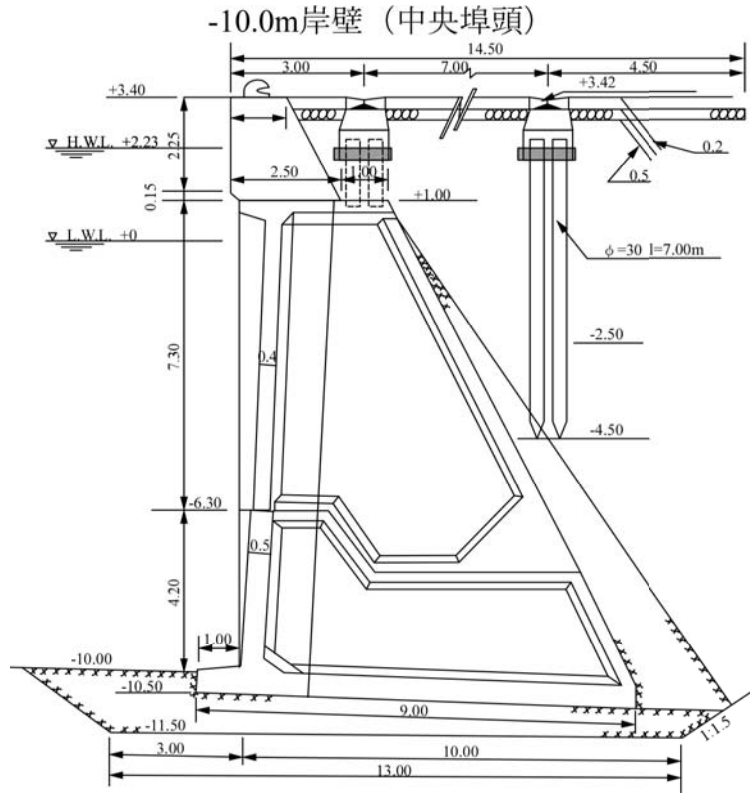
中央埠頭西側-10m 岸壁・栈橋の標準断面図 (L 型と栈橋)
